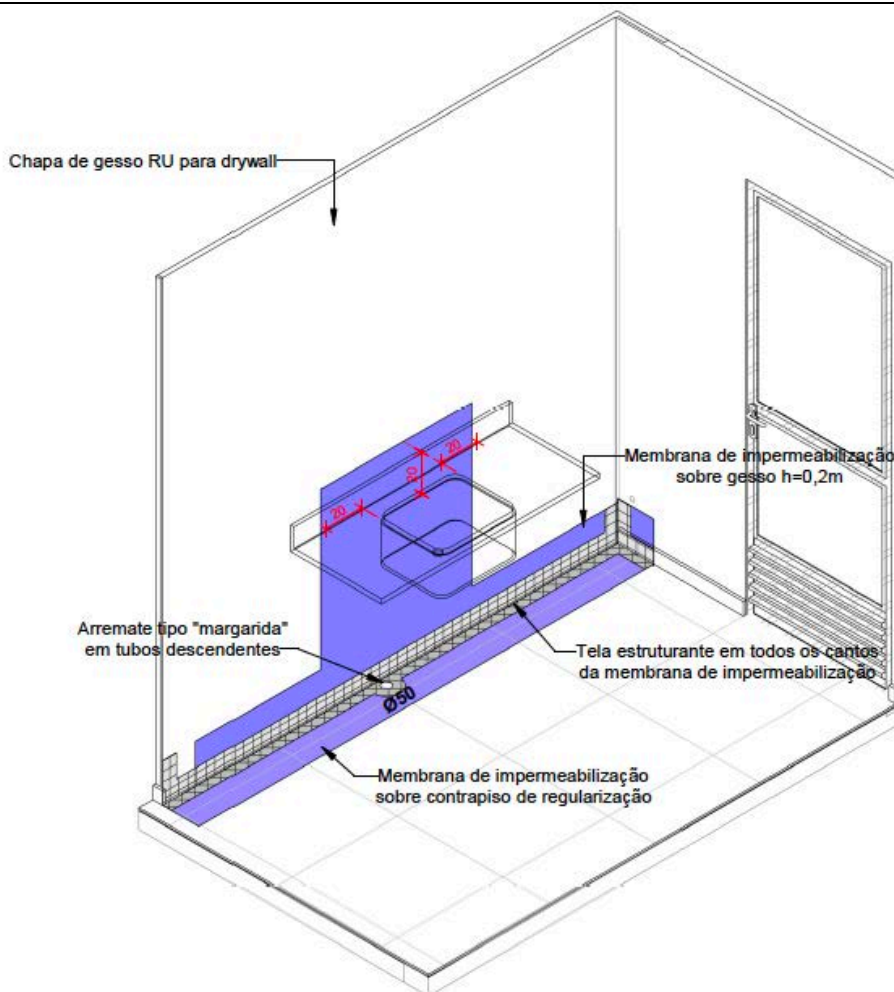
Desenho esquemático da impermeabilização da cozinha (área molhável) no pavimento térreo.
